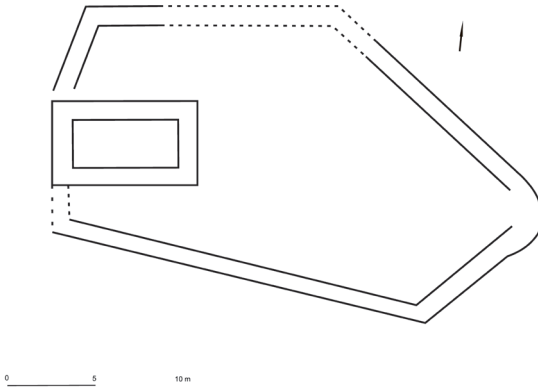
Croquis de planta de la fortificación de La Herradura (Berrocal).
